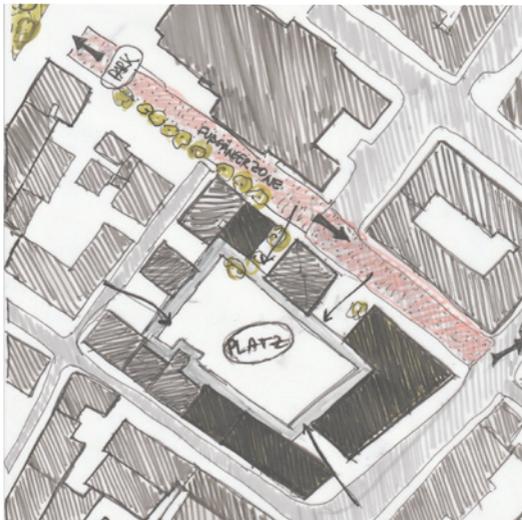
Zweite Variante mit zwei solitäre Baukörper und einen Zubau
